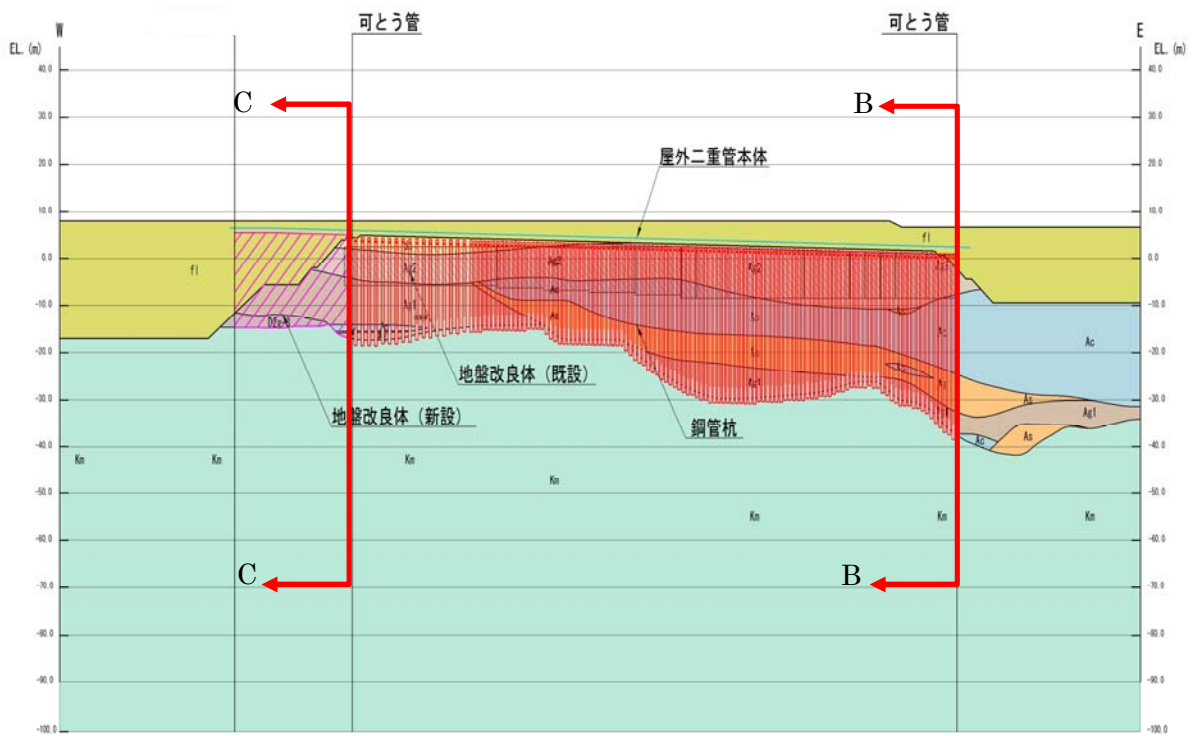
屋外二重管本体の基礎構造部縦断面図
